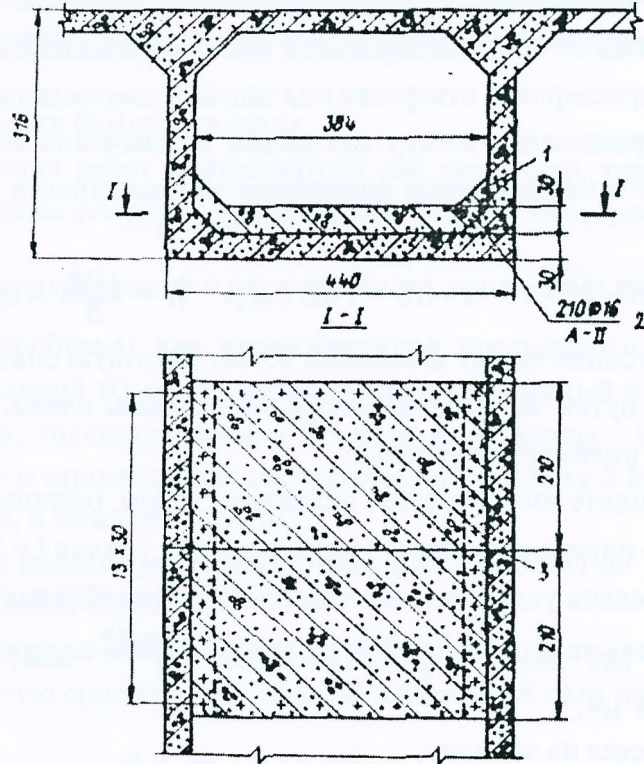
Схема усиления нижней плиты балки составного по длине пролетного строения в зоне дефектного стыка: 1 – бетон усиления; 2 – штыри диаметром 16 мм из арматурной стали кл.А-III; 3 – дефектный стык.
